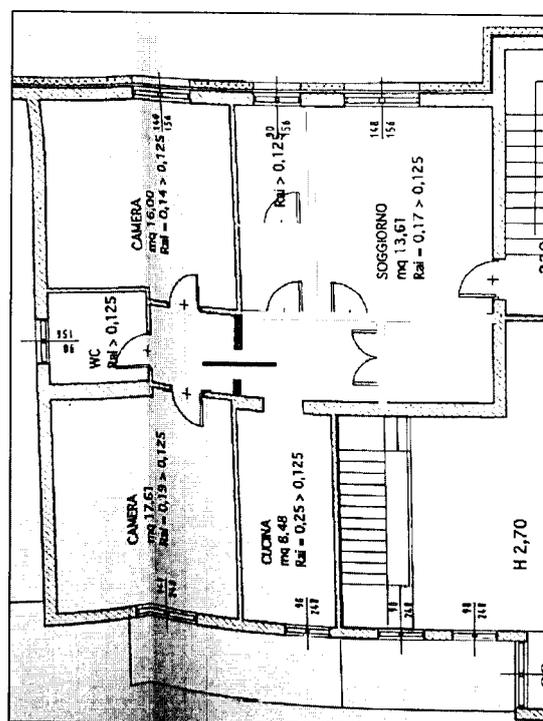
Stato rilevato al sopralluogo del 24.03.2023
